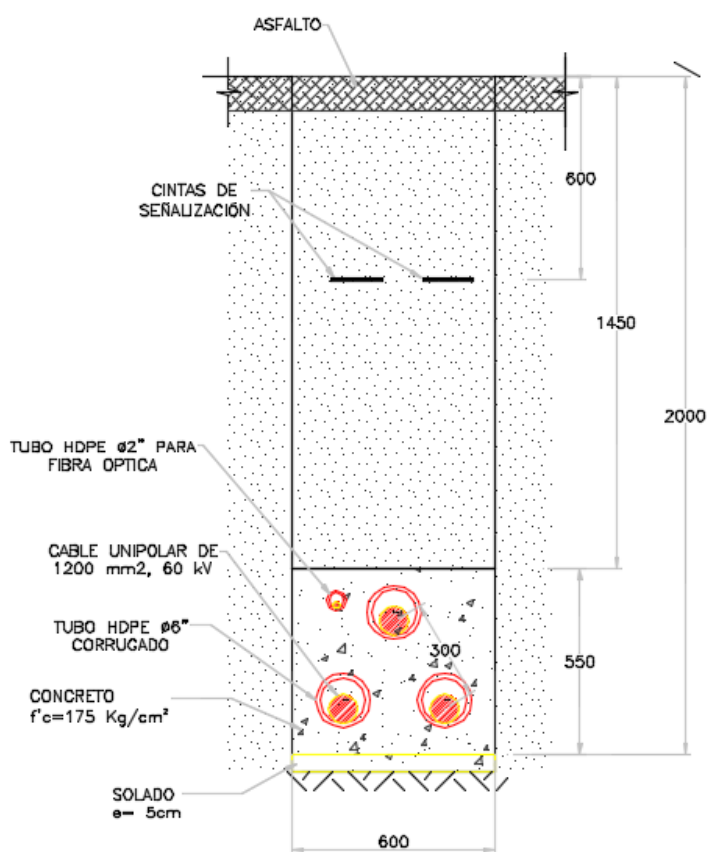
Ducto típico para ducto en concreto con tubería HDPE
